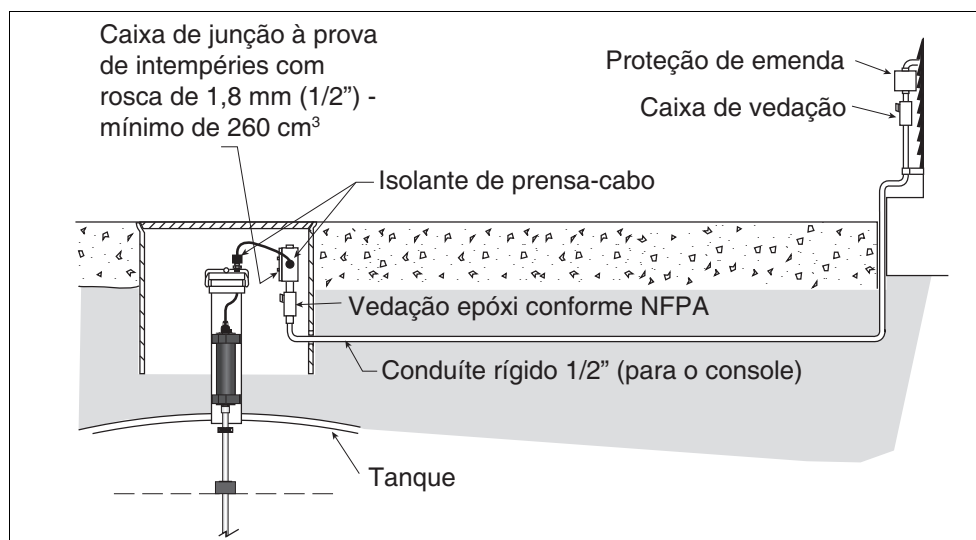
Exemplo de cabeamento de sonda em conduíte rígido enterrado
